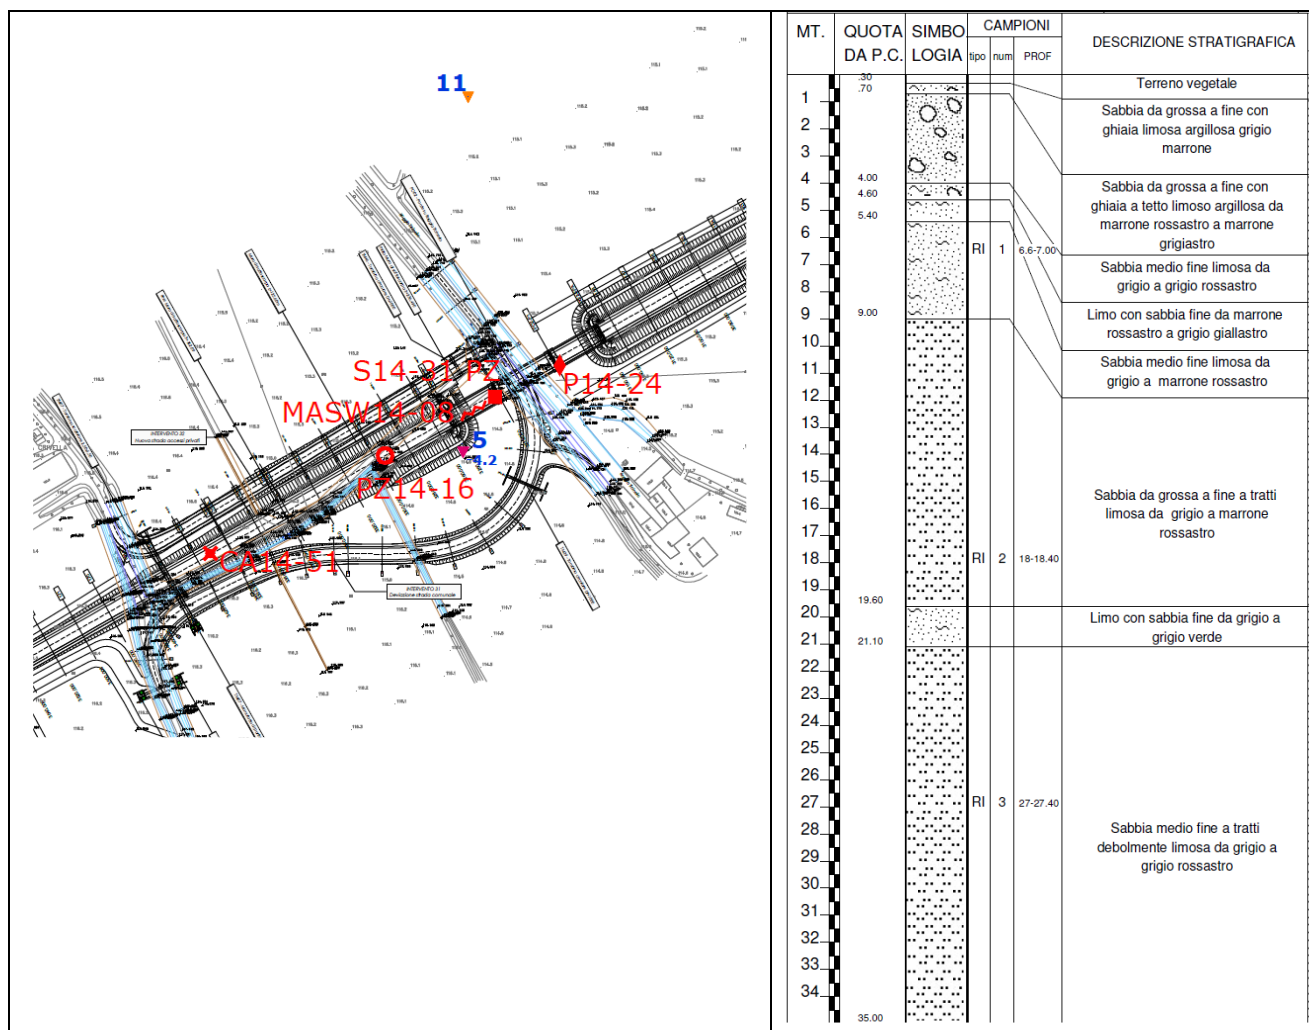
Stralcio planimetrico e stratigrafia sondaggio S14-31PZ
